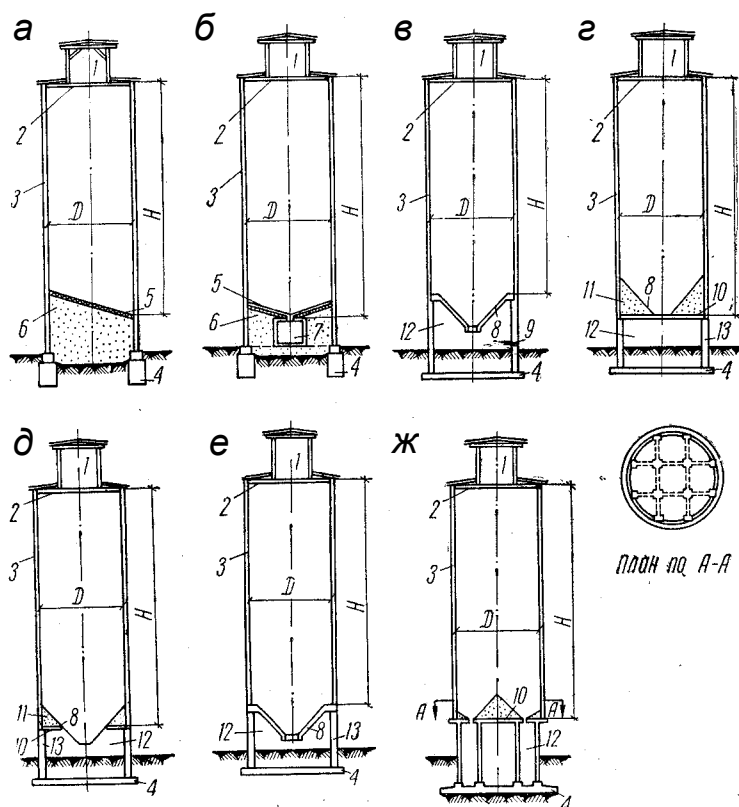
Различные схемы устройства силосов: а- без подсилосного этажа с разгрузкой через отверстие в стенке; б- то же. но с разгрузкой через специальные галереи под днищем; в- с конической воронкой, опирающейся на уступы утолщения стенок; г- с плоским железобетонным днищем и забутками; д- то же, но со стальной конической воронкой до половины диаметра силоса; е- с конической воронкой, опирающейся на отдельные колонны; ж- с плоским днищем, поддерживаемым колоннами по контуру стенок силоса и непосредственно под днищем; 1- верхняя галерея; 2- перекрытия; 3- стенки силоса; 4- фундамент; 5- бетонный пол; 6- песчаная подсыпка; 7- нижняя галерея; 8- железобетонная или стальная воронка; 9-утолщение стенки; 10- днище силоса; 11- забутка; 12- подсилосный этаж; 13-колонны
